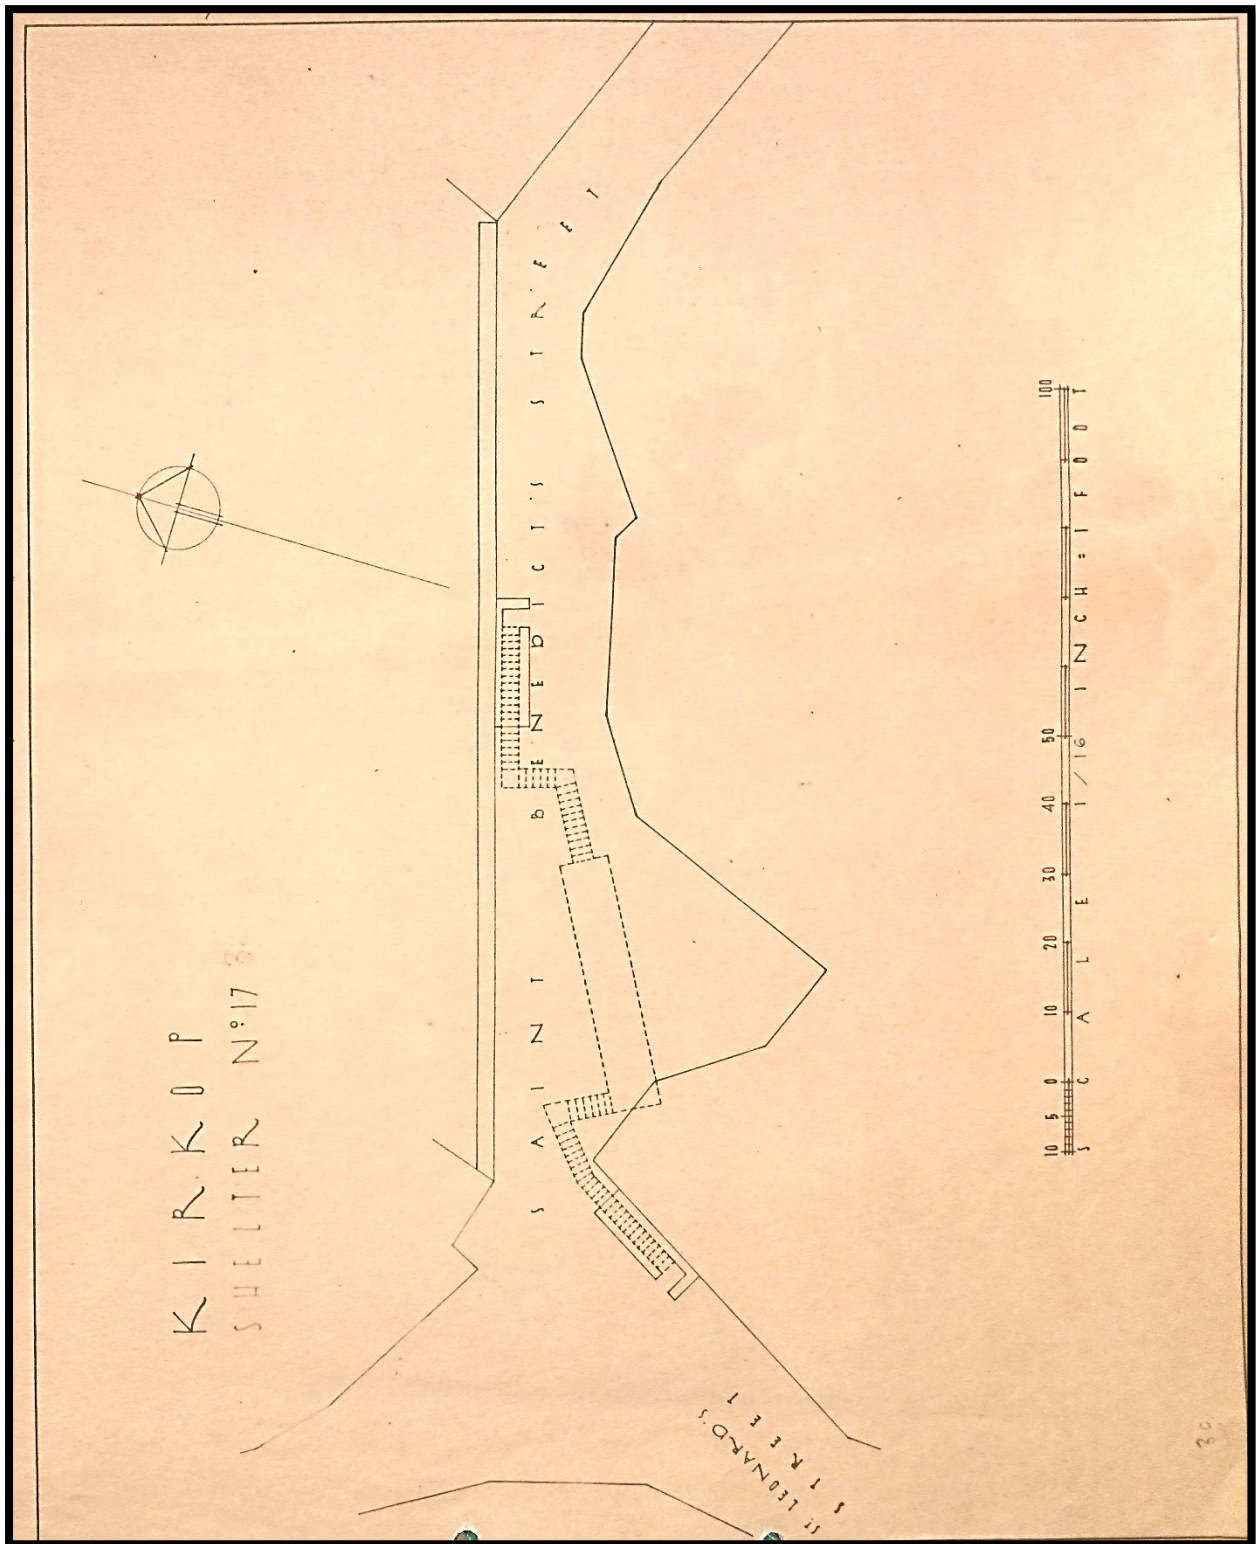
Planta do Abrigo nº 17 "Saint Benedict's Street."
